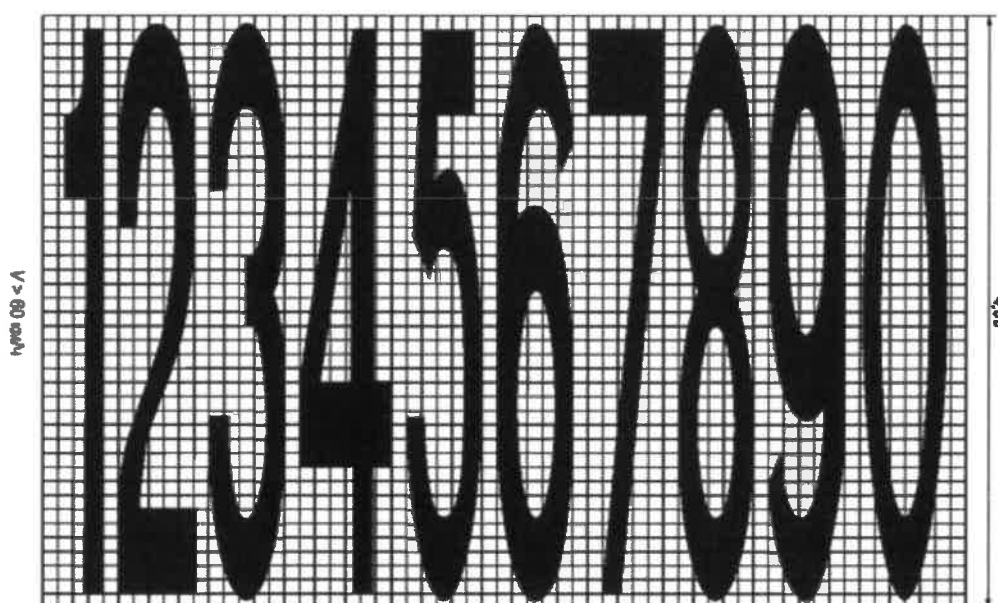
Форма, расположение и размеры цифр разметки типа 1.22
